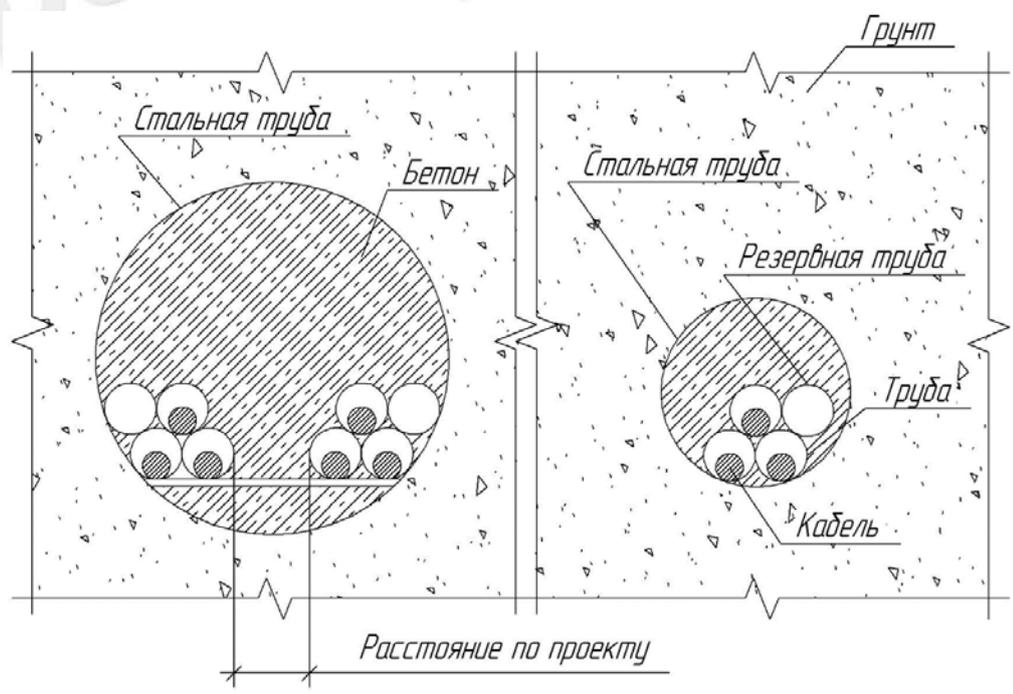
Прокладка КЛ в трубах под железными дорогами (поперечный разрез).
